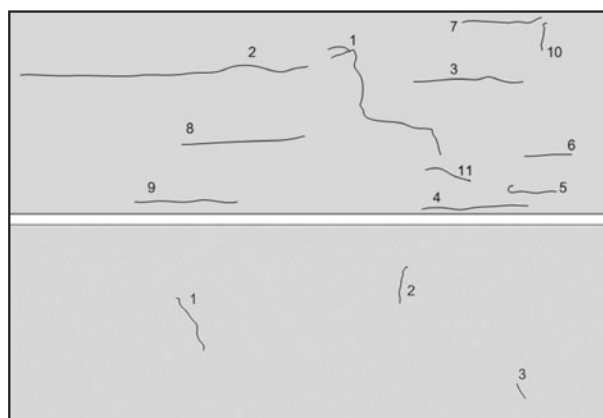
Rissbilder in den Schwindplatten mit Beton B-Ref (oben) und Beton B-2 (unten)
